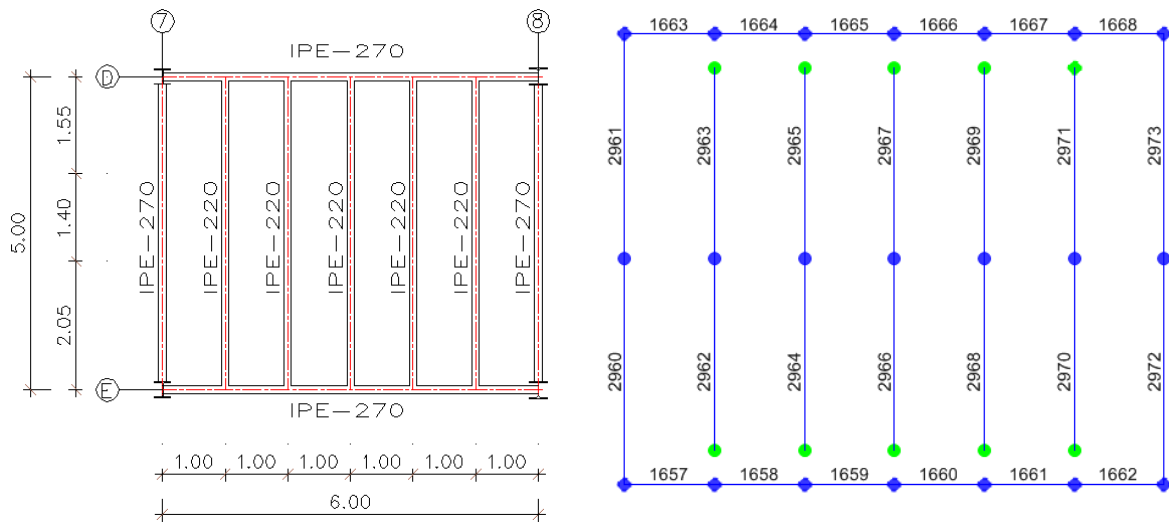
Planta com a Geometria e Identificação das Vigas Interiores do Piso 1 dos Alinhamentos 7 e 8.
